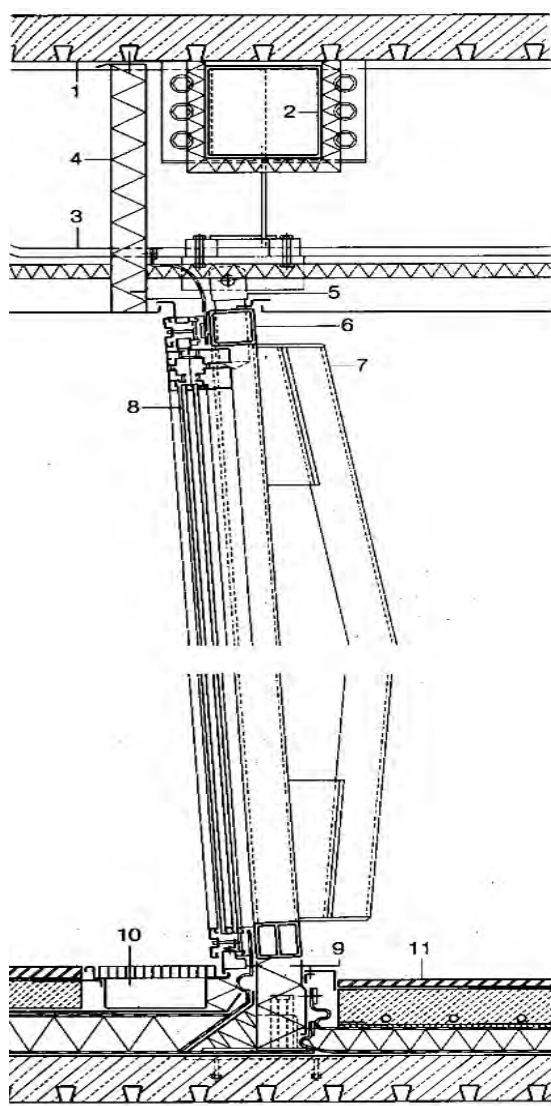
Схема конструкции наружных светопрозрачных ограждений:
